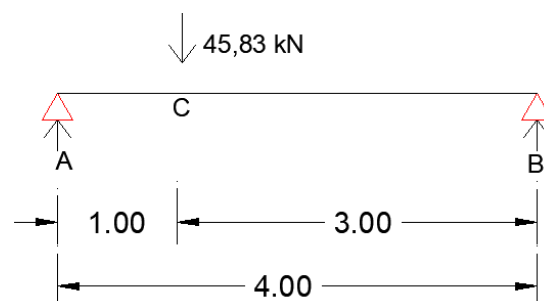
Viga biapoyada carga puntual sobre "C" 45,83 kN
